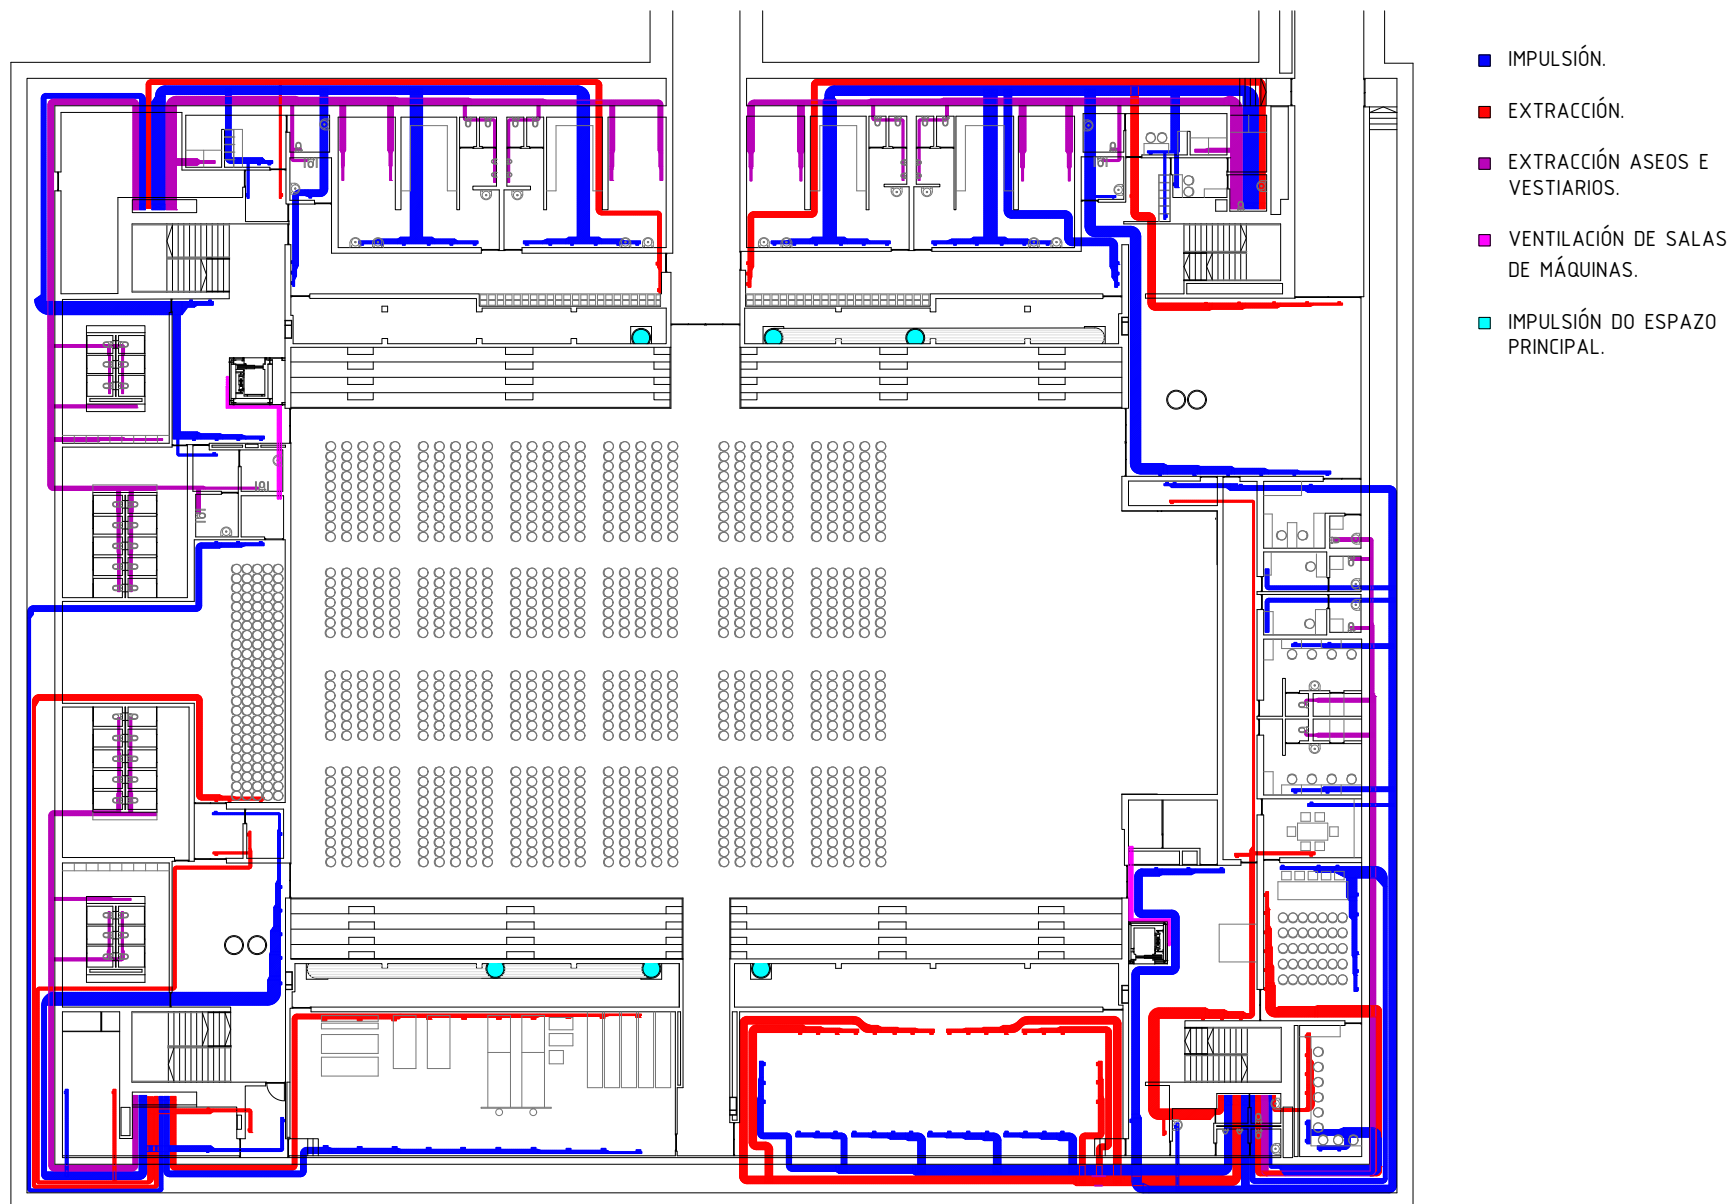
Planta baixo chan de HVAC. Escala 1/400.
